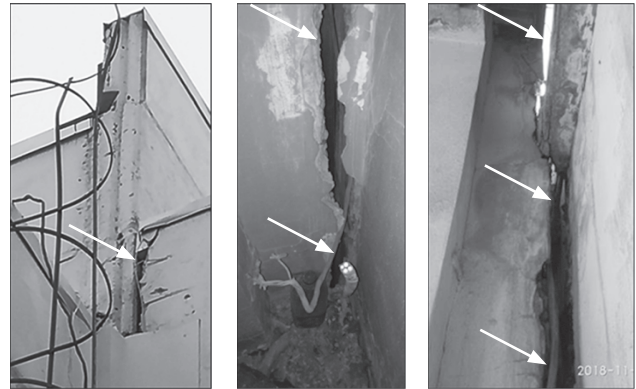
Проседание грунтов основания под фундаментами лестничной клетки привело к образованию трещин между конструкциями до 150 мм
